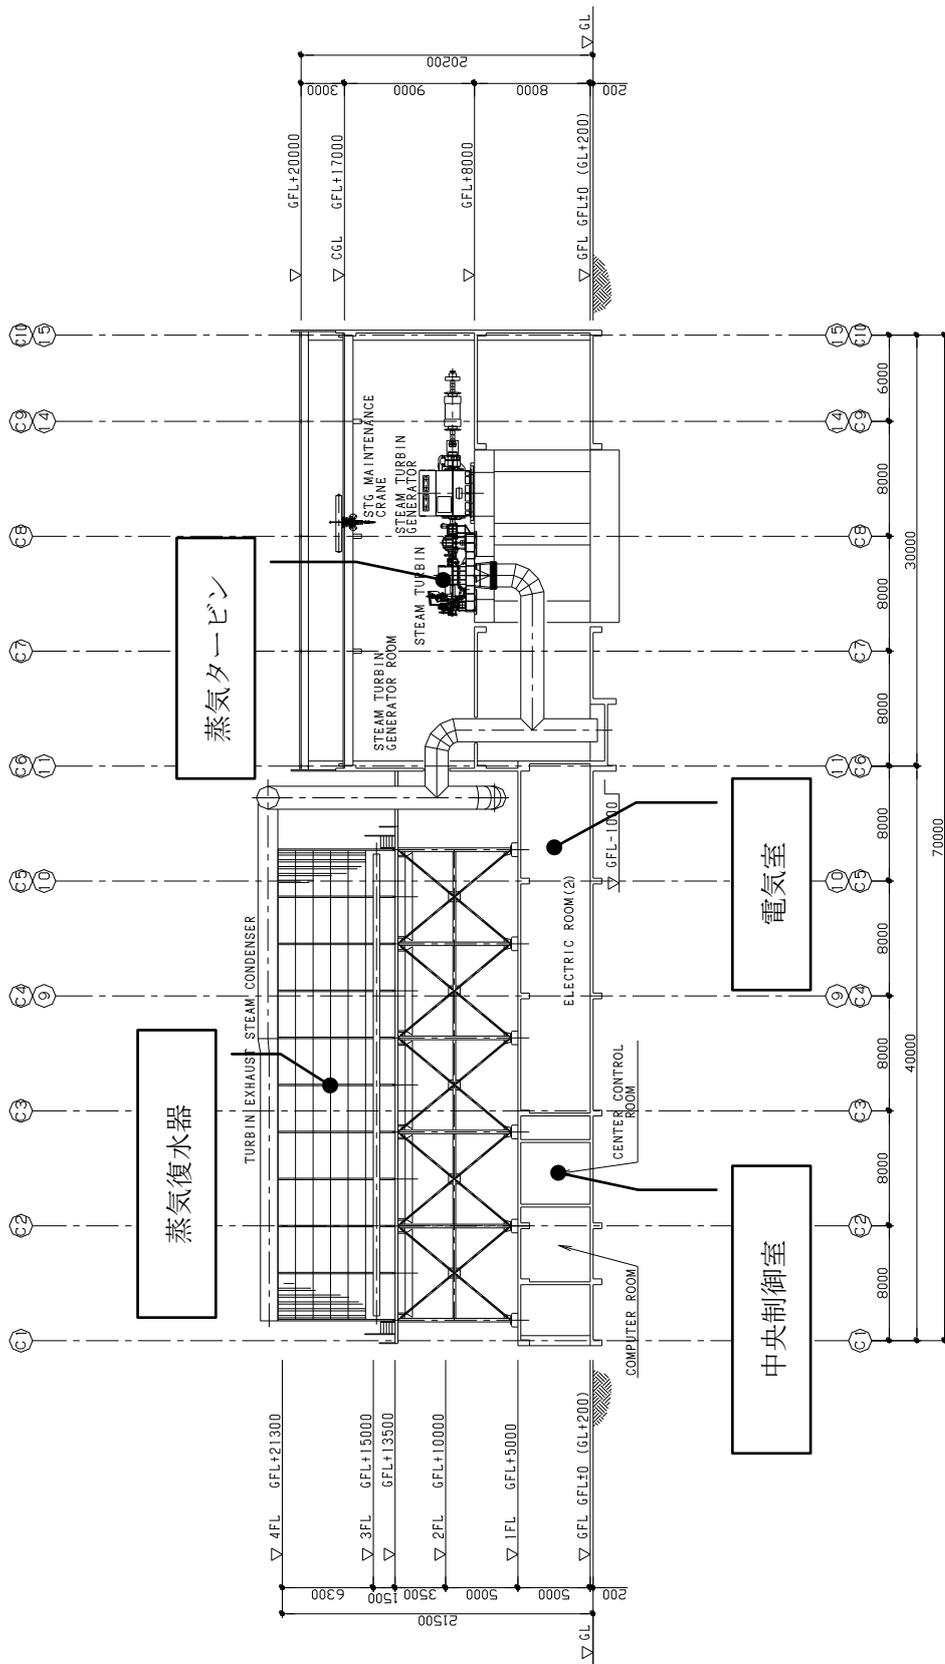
機器配置図 (タービン・コンデンサ縦断面図)
